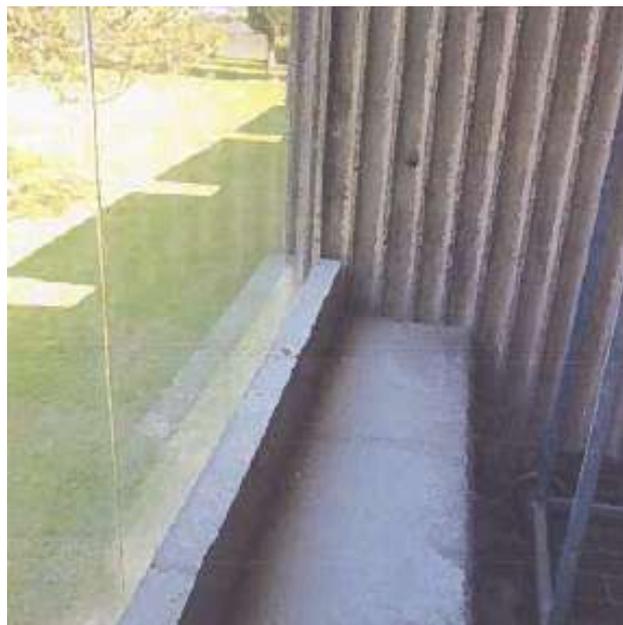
"Blocco A" – parapetto inesistente; si prevede di realizzarne uno in profilati metallici (come esistenti).
